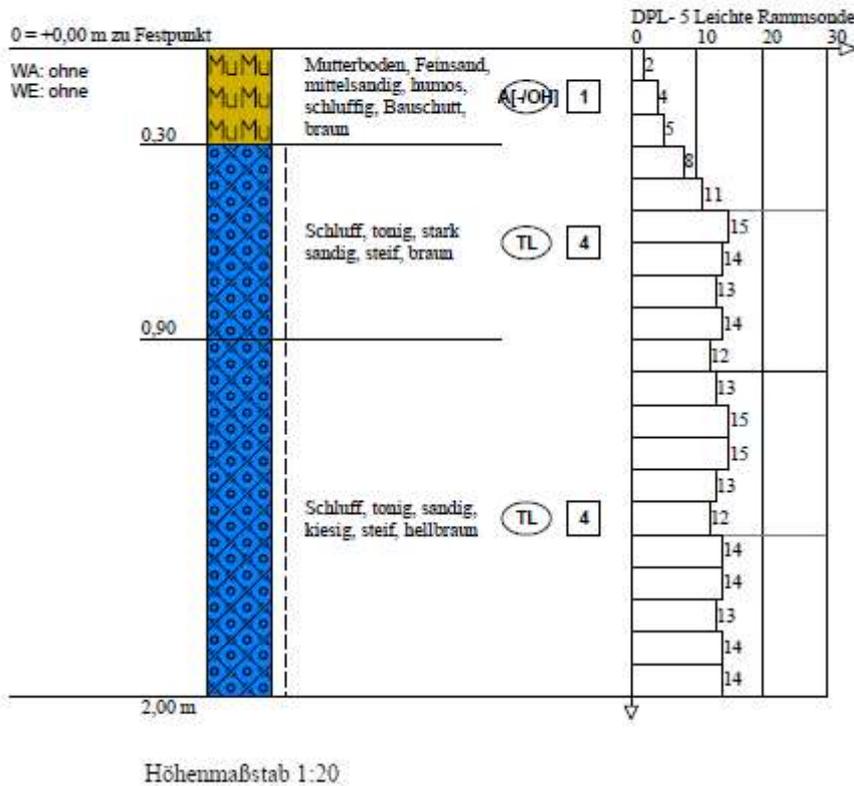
Baugrunduntersuchung Ingenieurbüro Lehmann Stendal OT Uenglingen, Neubau Radweg K 1037, Anlage 4, Bohrpunkte
